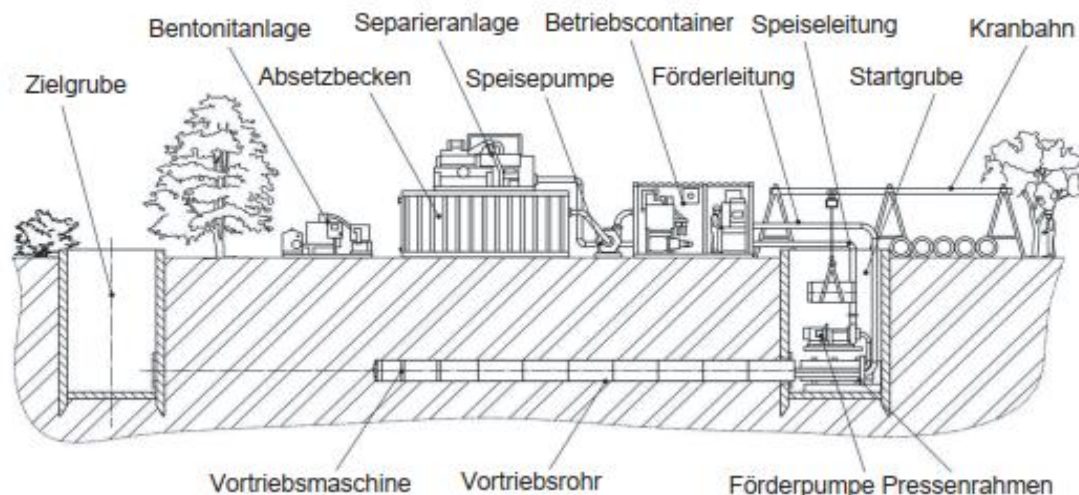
Schematische Darstellung Mikrotunnelbau mit Spülförderung (nach DVGW GW 304 Abschnitt 6.1.3.1.3)
